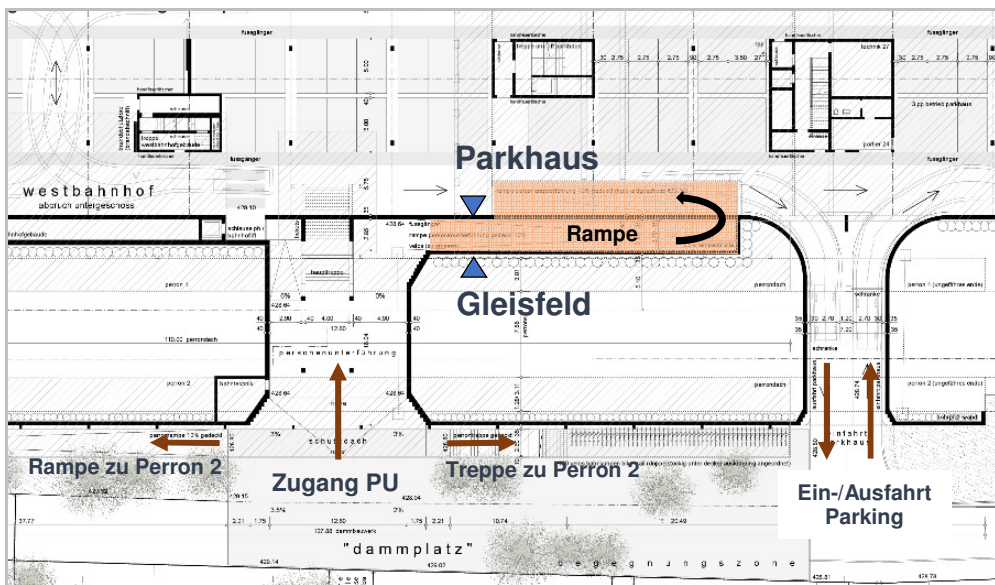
Plan Untergeschoss / Ebene Dammstrasse, mit Zugängen Personenunterführung und Parkhaus. Der Bereich für die Rampe ab Westbahnhofplatz in die Personenunterführung hinunter ist in Rot dargestellt.
